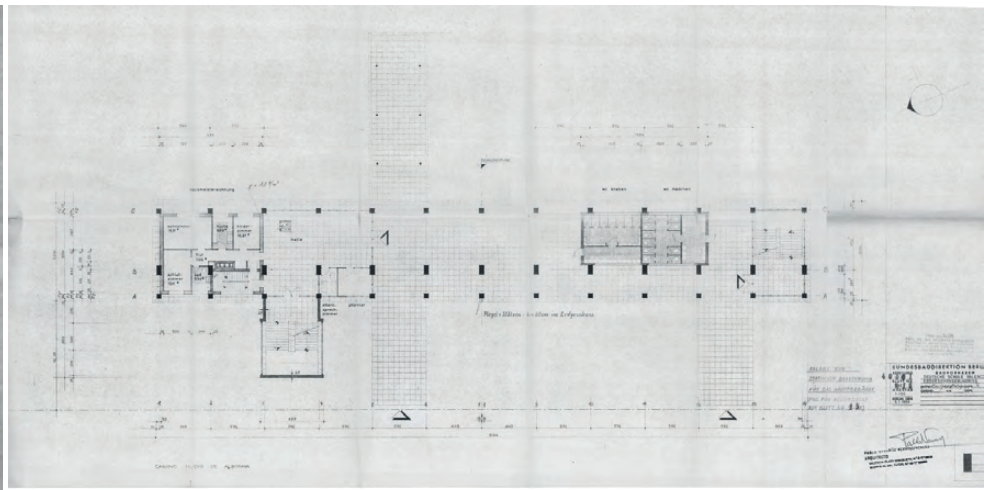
Planta baja del proyecto del Colegio Alemán, ubicado en la calle Jaime Roig (1957). Archivo Fam. Navarro / Figure 9. Ground floor of the German School project, located on Jaime Roig Street (1957). Archivo Fam. Navarro.
